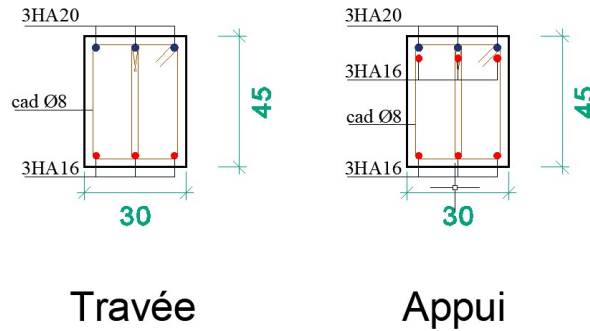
Schémas de ferrailage des Poutres principales.
